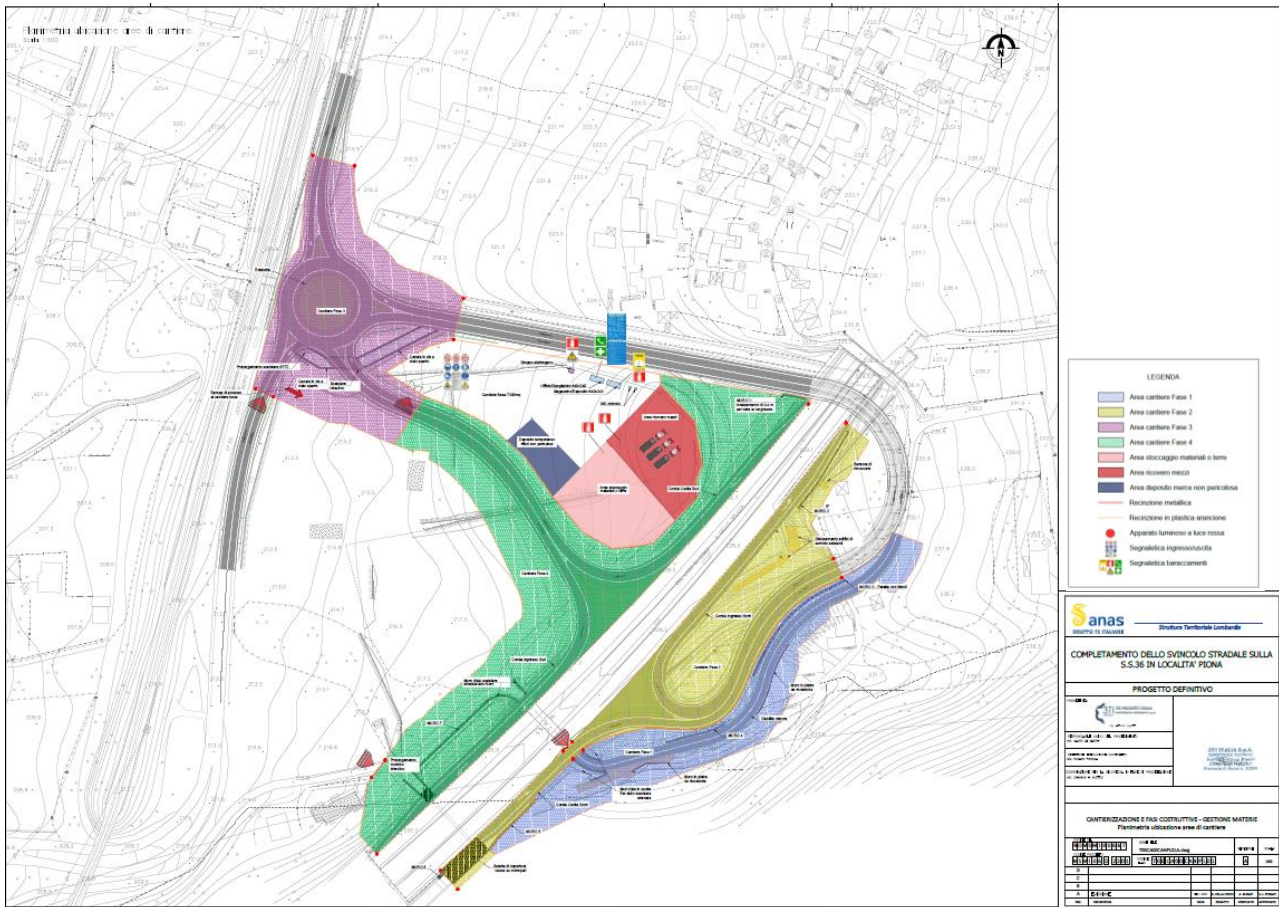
Cantierizzazione e fasi costruttive – gestione materie - Planimetria ubicazione aree di cantiere
